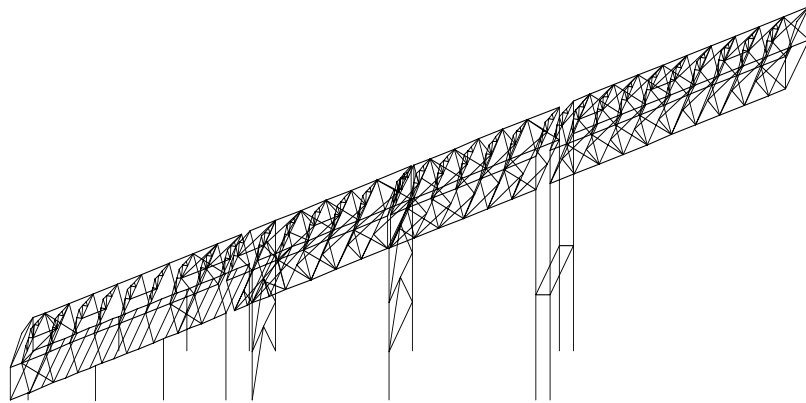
Загальний вигляд розрахункової схеми транспортної галереї У3-У4
